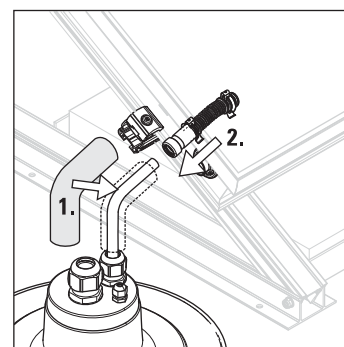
Doorvoering van de verbingsleiding rechtstreeks aan de collectoraansluiting
